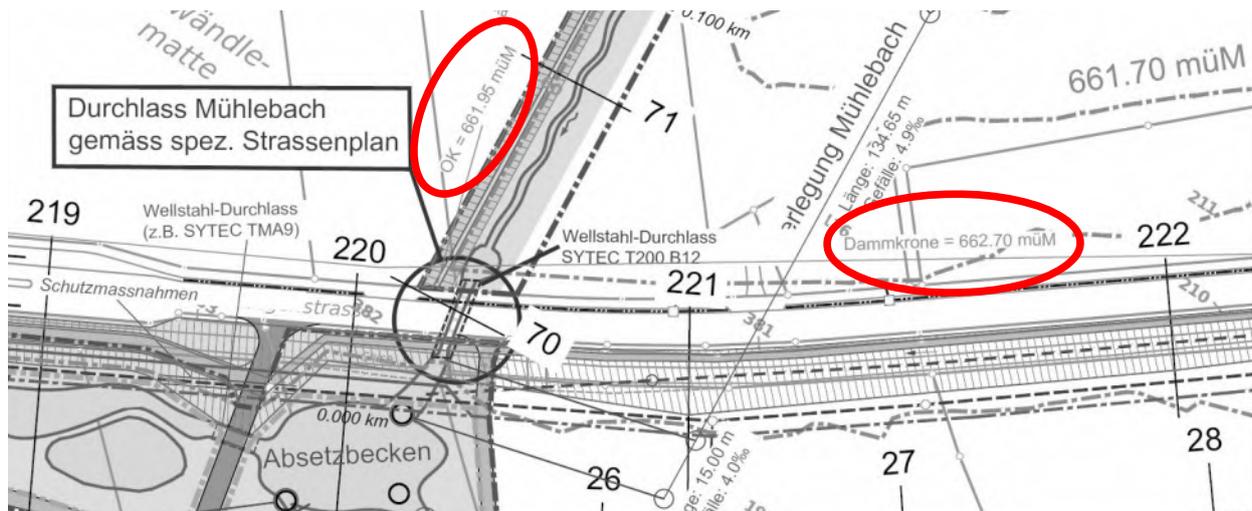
Auszug aus dem Plan Nr. 22012-26P "Korrektion Chisebach und Hochwasserrückhalt Hünigenmoos", 2. Auflage. Dammkrone (662.70 m ü. M.) > OK Damm Mühlebach (661.95 m ü. M.). Stauziel 659.50 m ü. M., Überstau bei HQ_{1000} 662.55 m ü. M.
